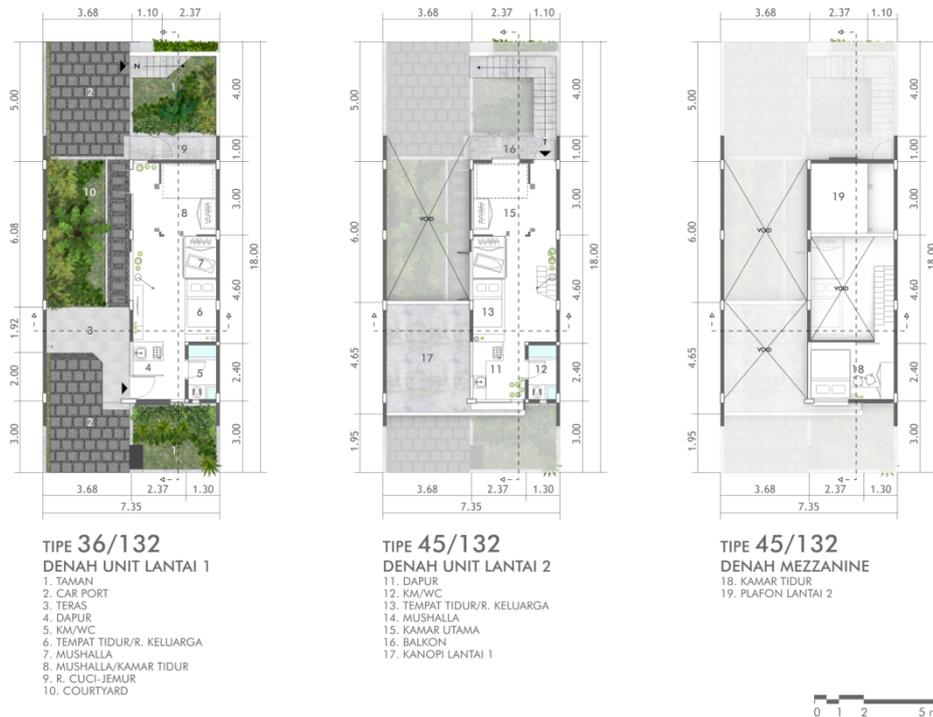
Denah Rumah Tapak Tipe Kecil 1
